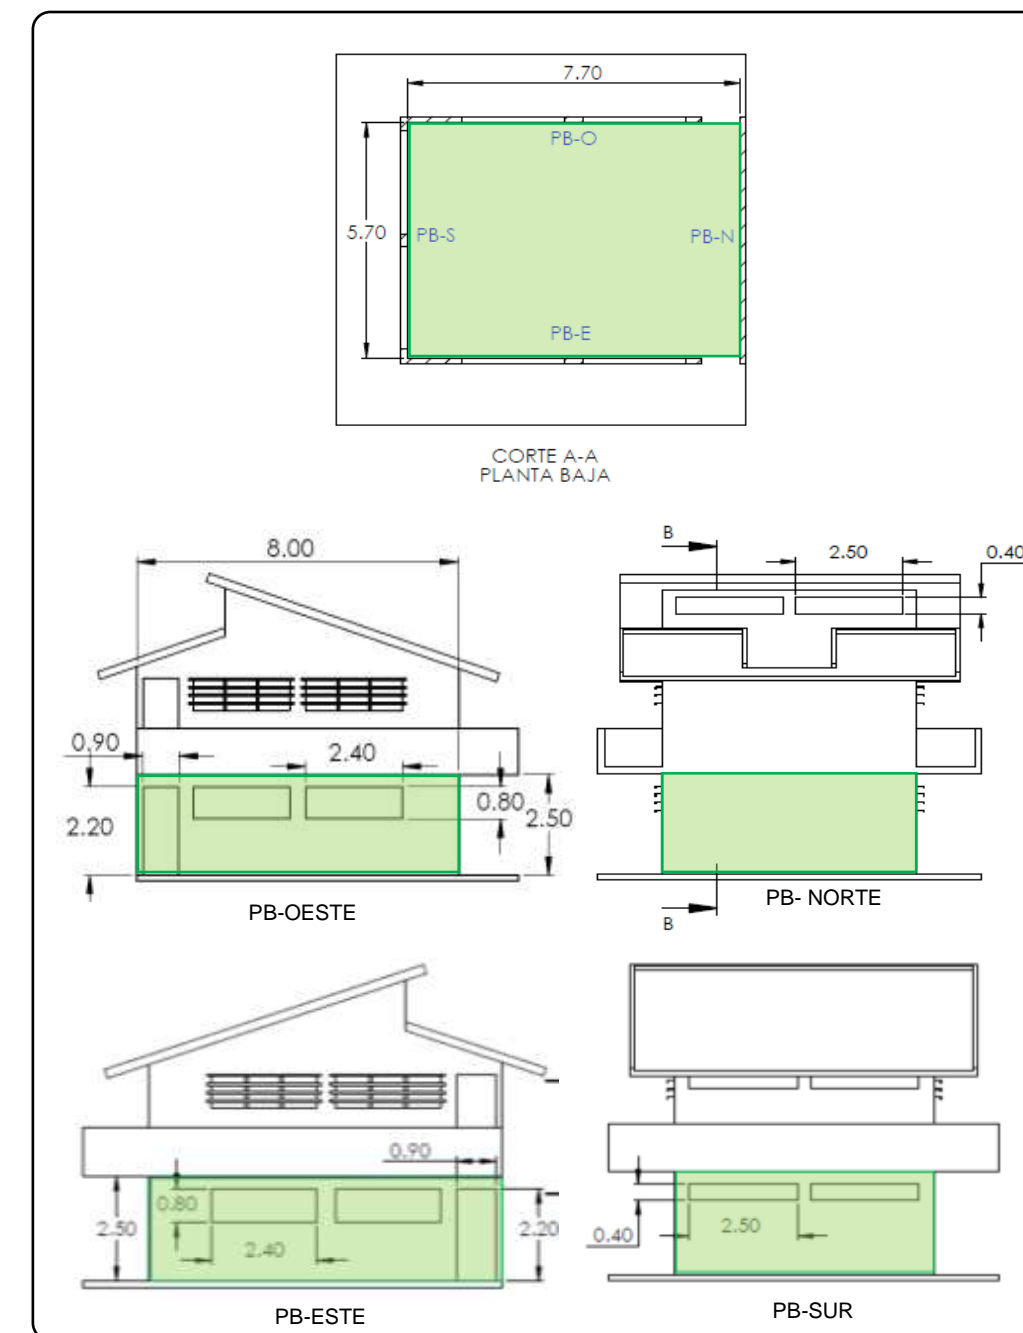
Planos ilustrativos del espacio de estudio en Planta Baja. Fuente: Elaboración propia.
